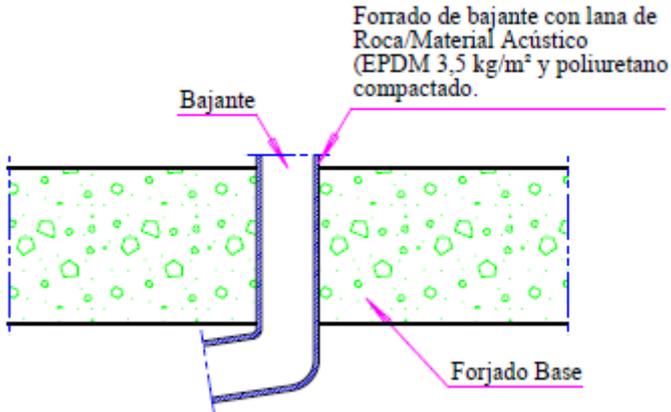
Forjado de bajante con aislamiento. Fuente Propia
